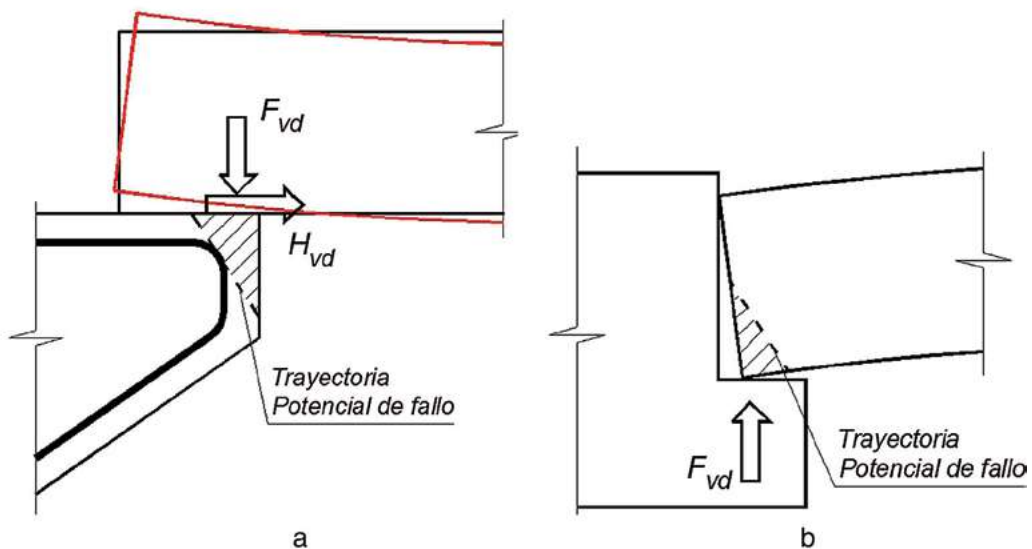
Mecanismo de fallo por descantillado en apoyos de elementos prefabricados.
